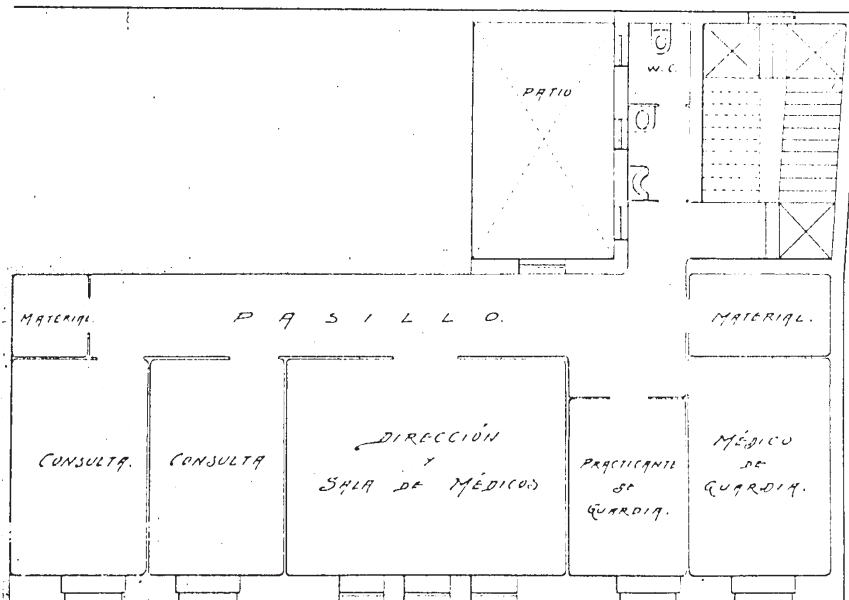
Planta baja de la Casa de Socorro. Legajo Archivo Municipal de Valladolid.
